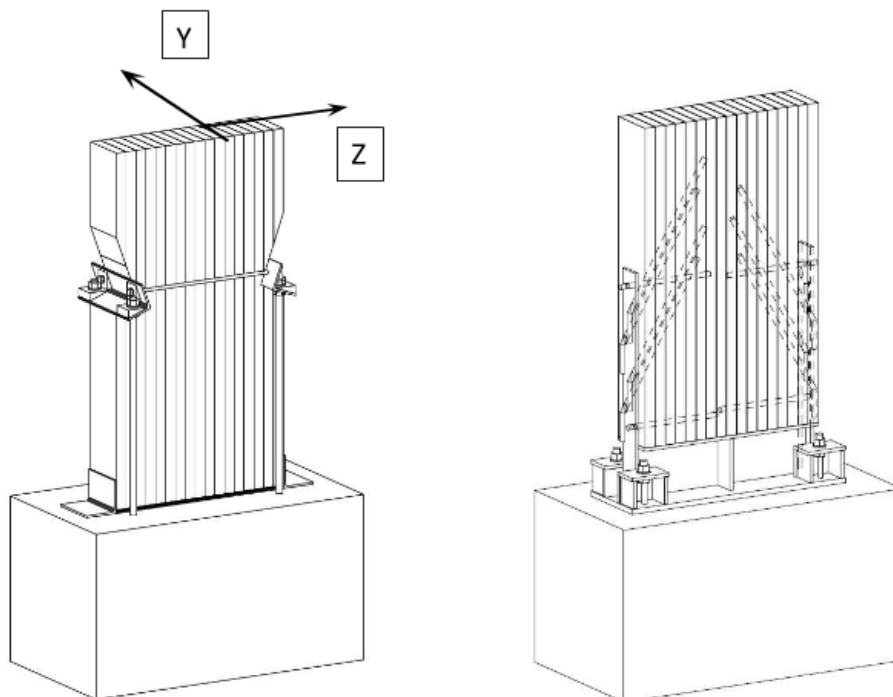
Варіанти жорсткого кріплення колон до фундаменту
